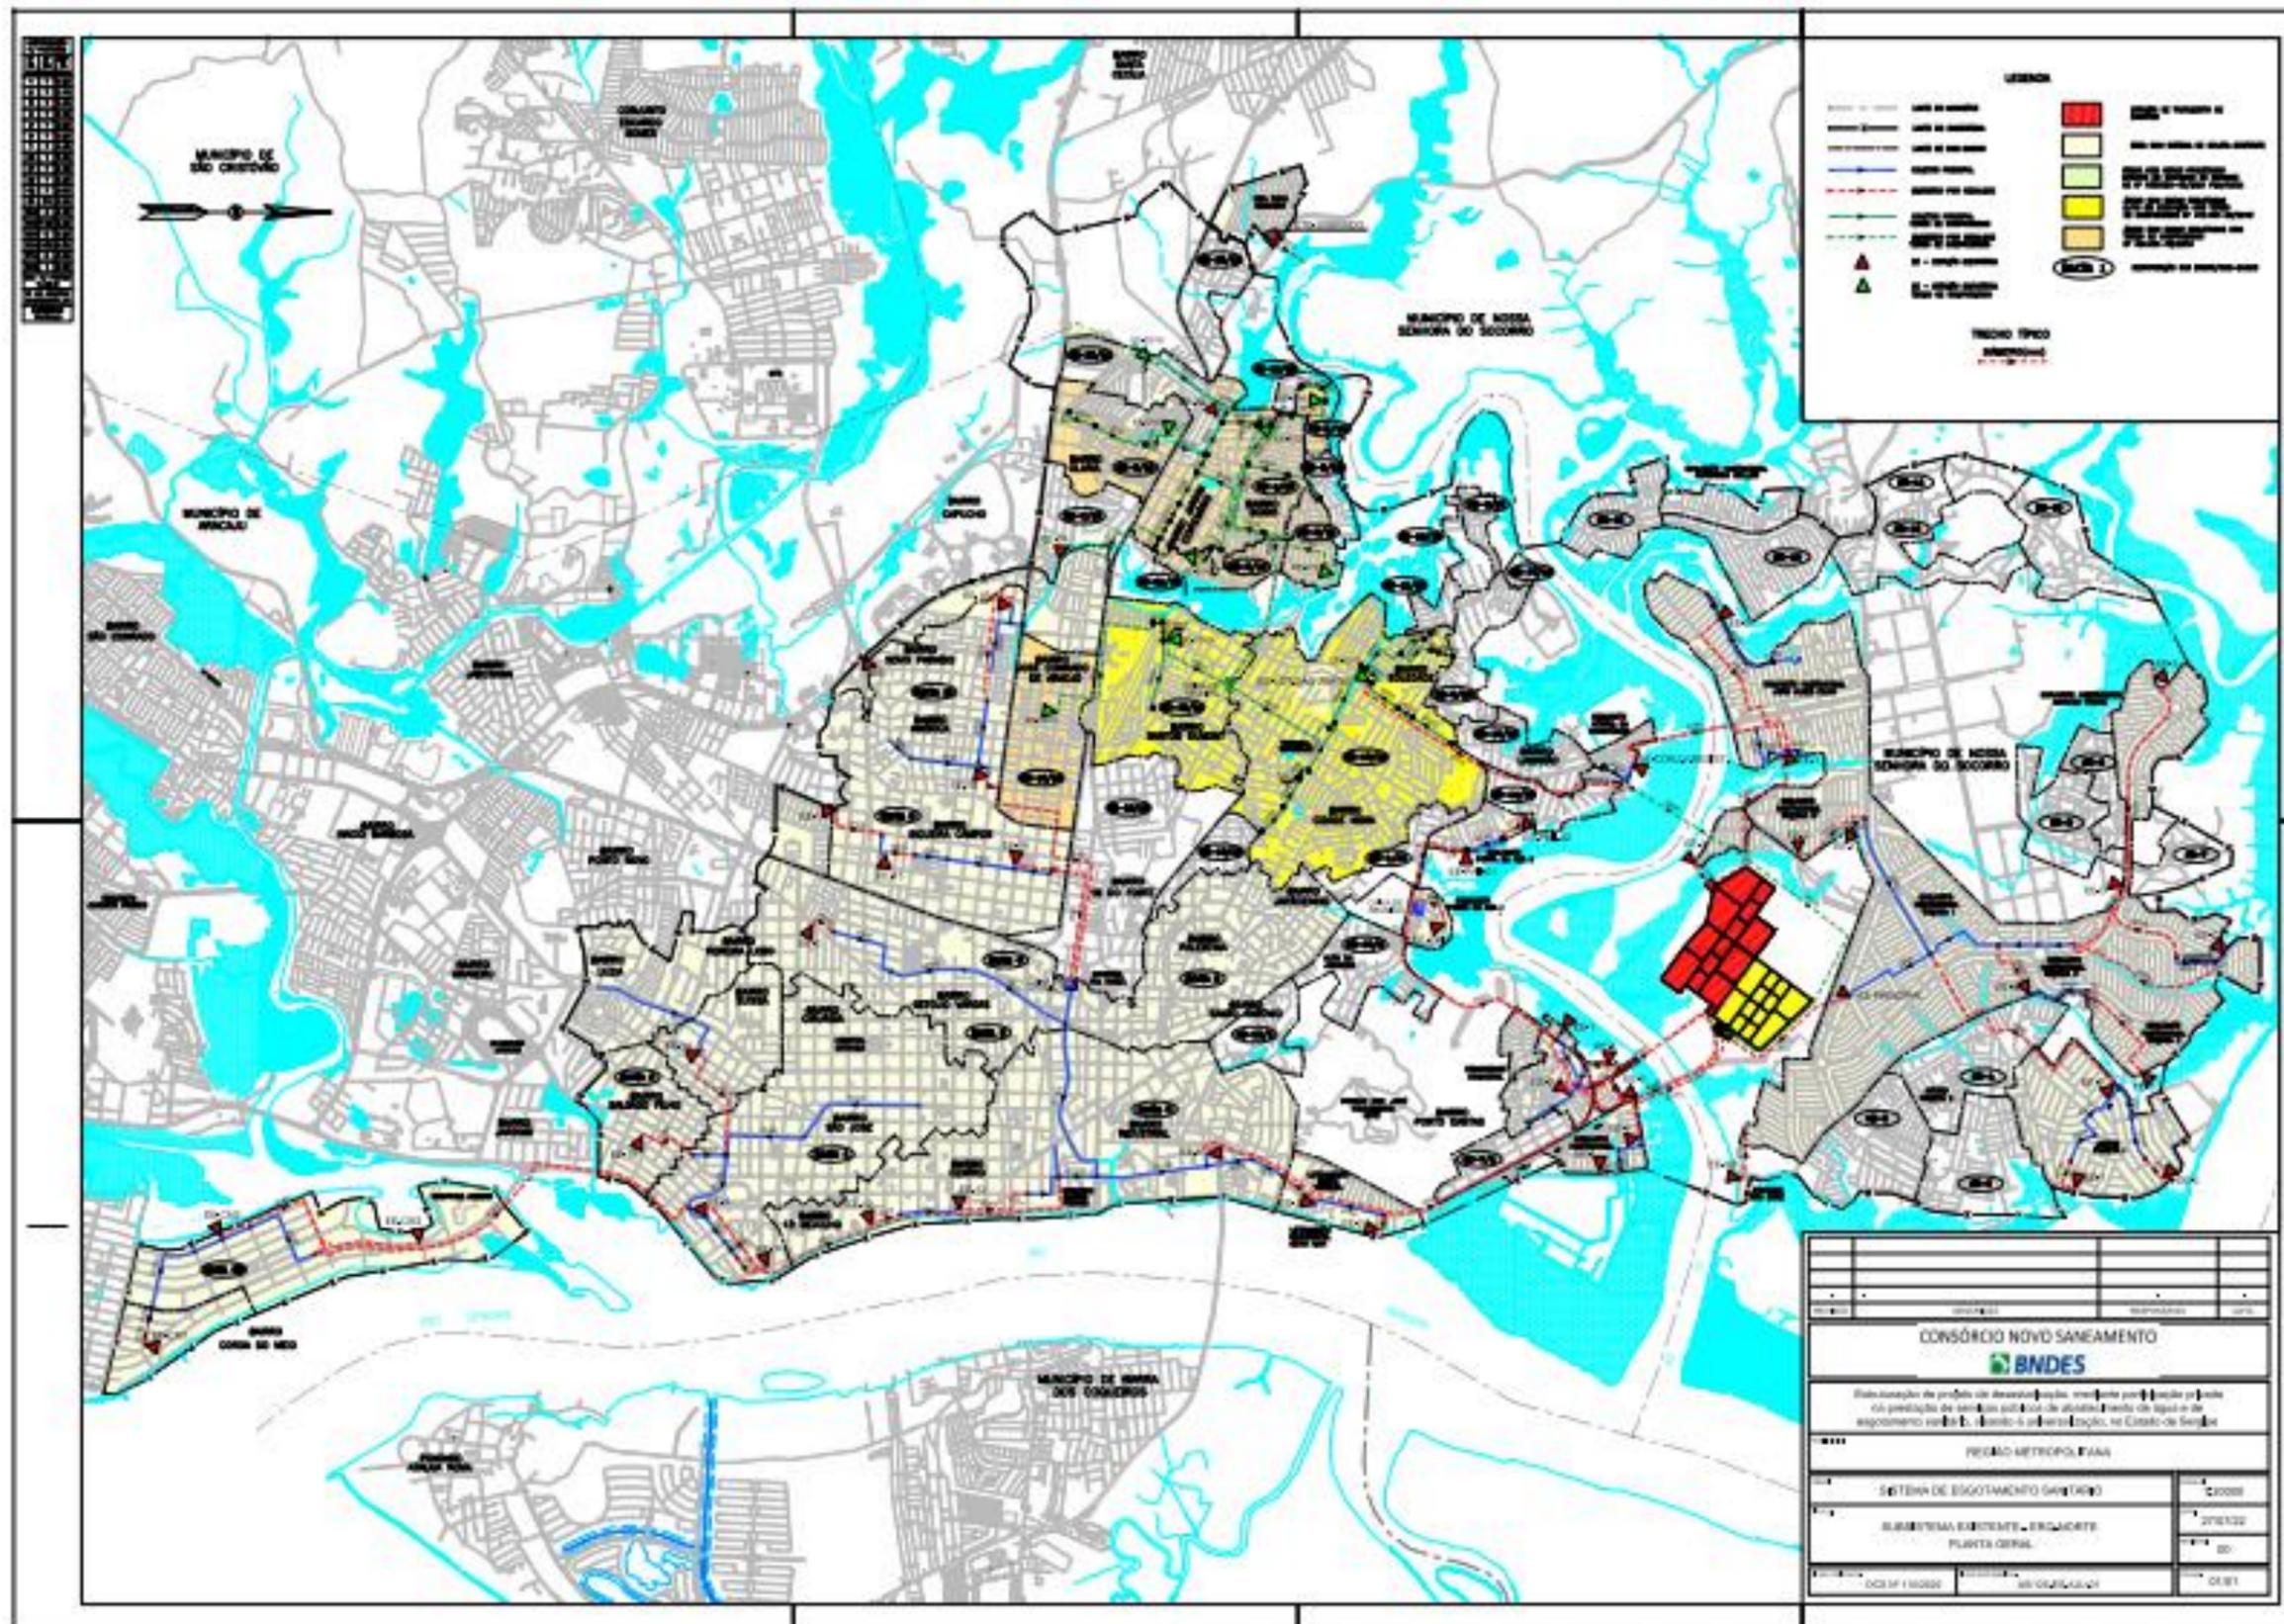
Planta do Sistema de Esgotamento Sanitário da Região Metropolitana – ERQ NORTE
